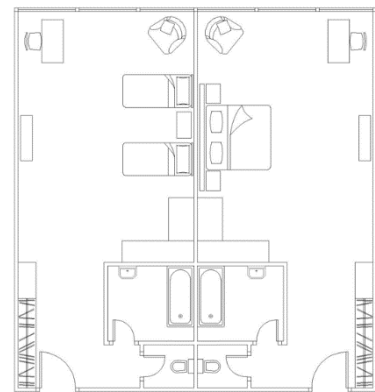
Plan type d'étage des chambres (Source : L'auteure)
